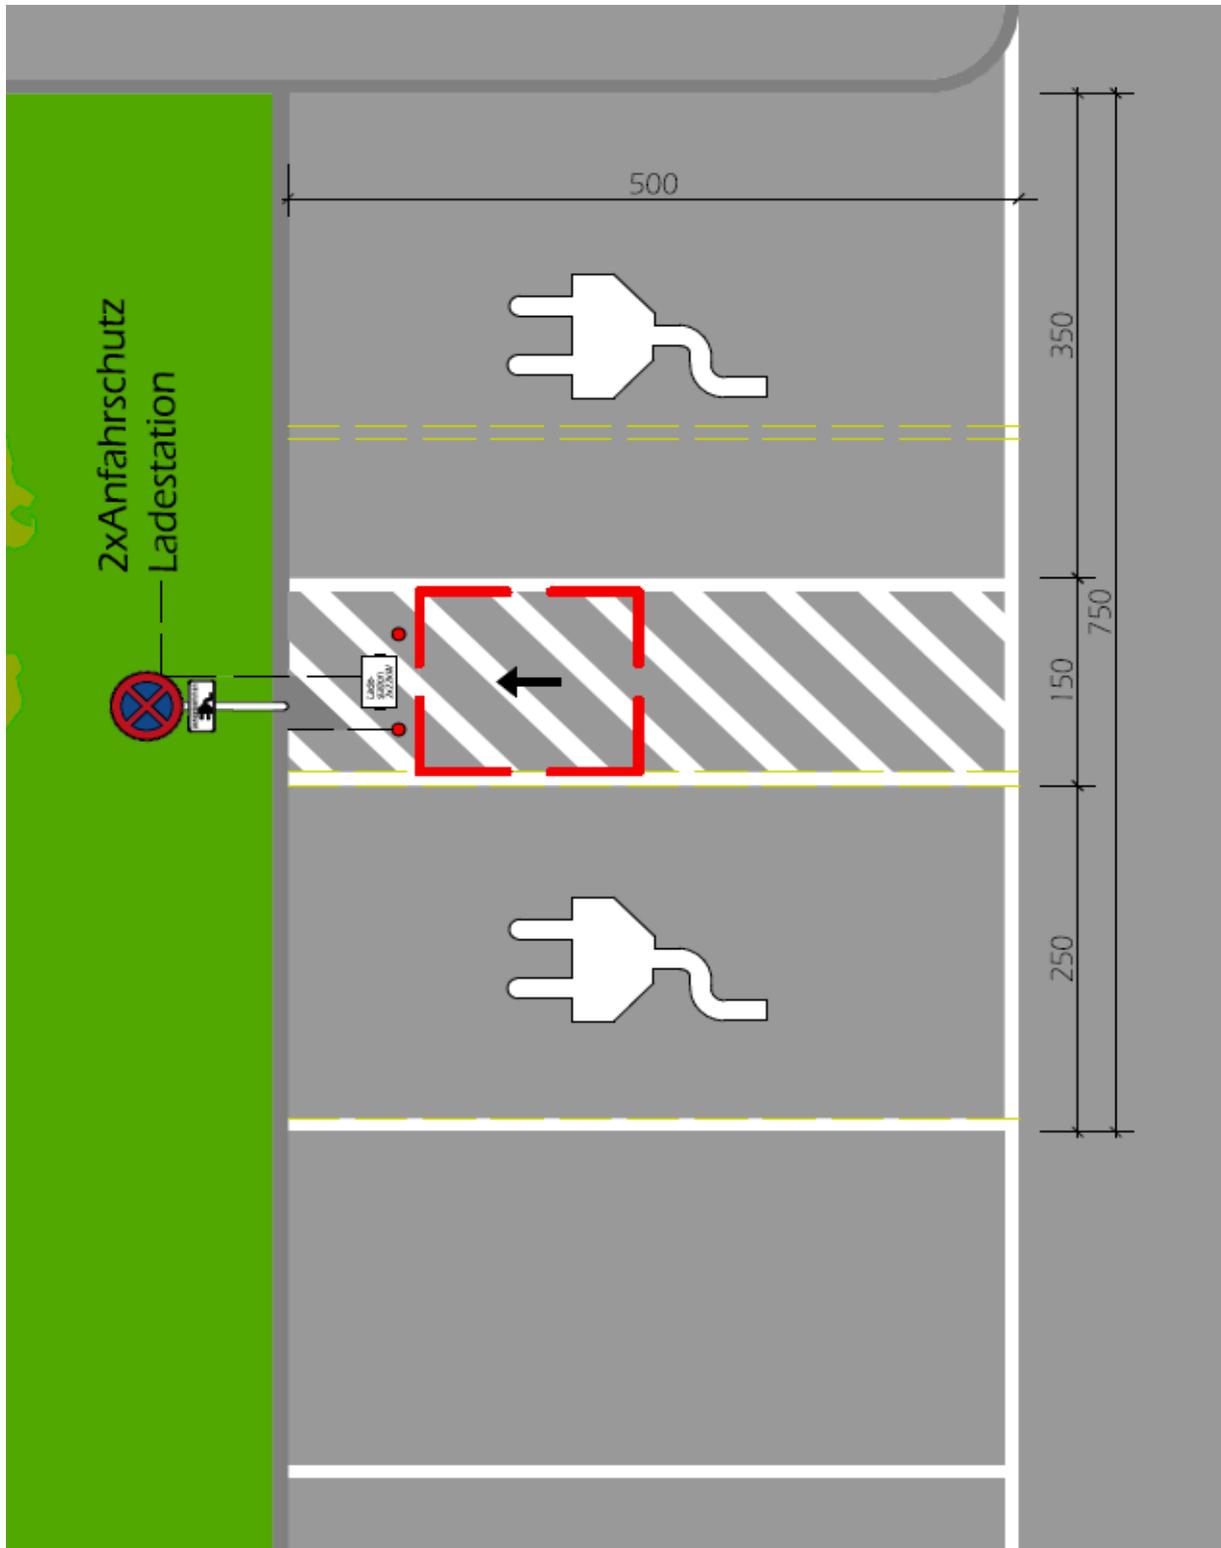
Neue E-Ladestation mit zwei Ladepunkten
